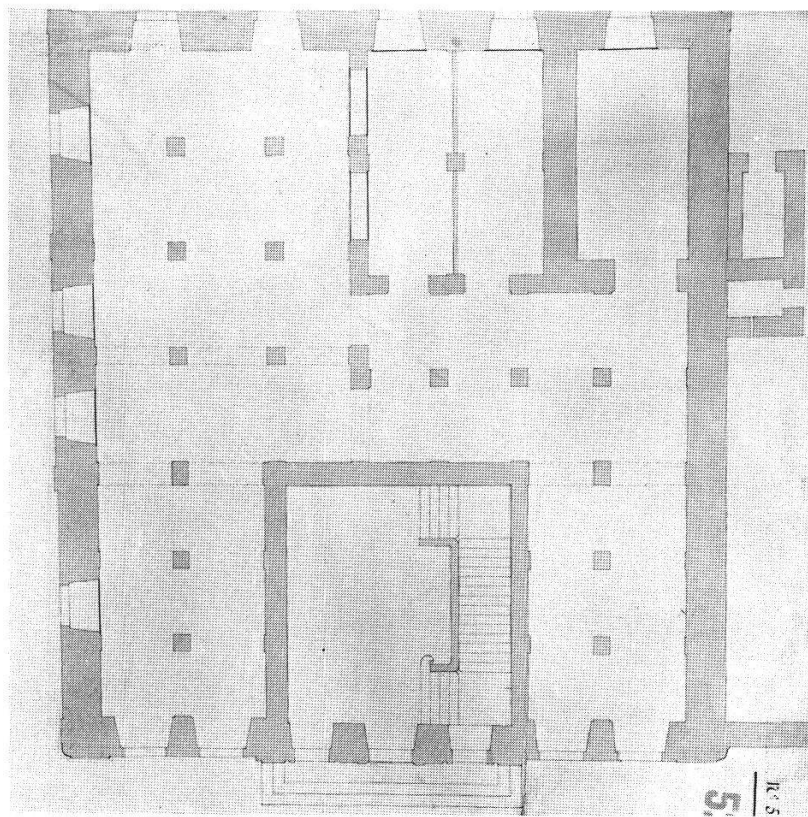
L'hôtel de ville d'Yverdon. Le plan du rez-de-chaussée adopté, 1767 (AC Yverdon).
